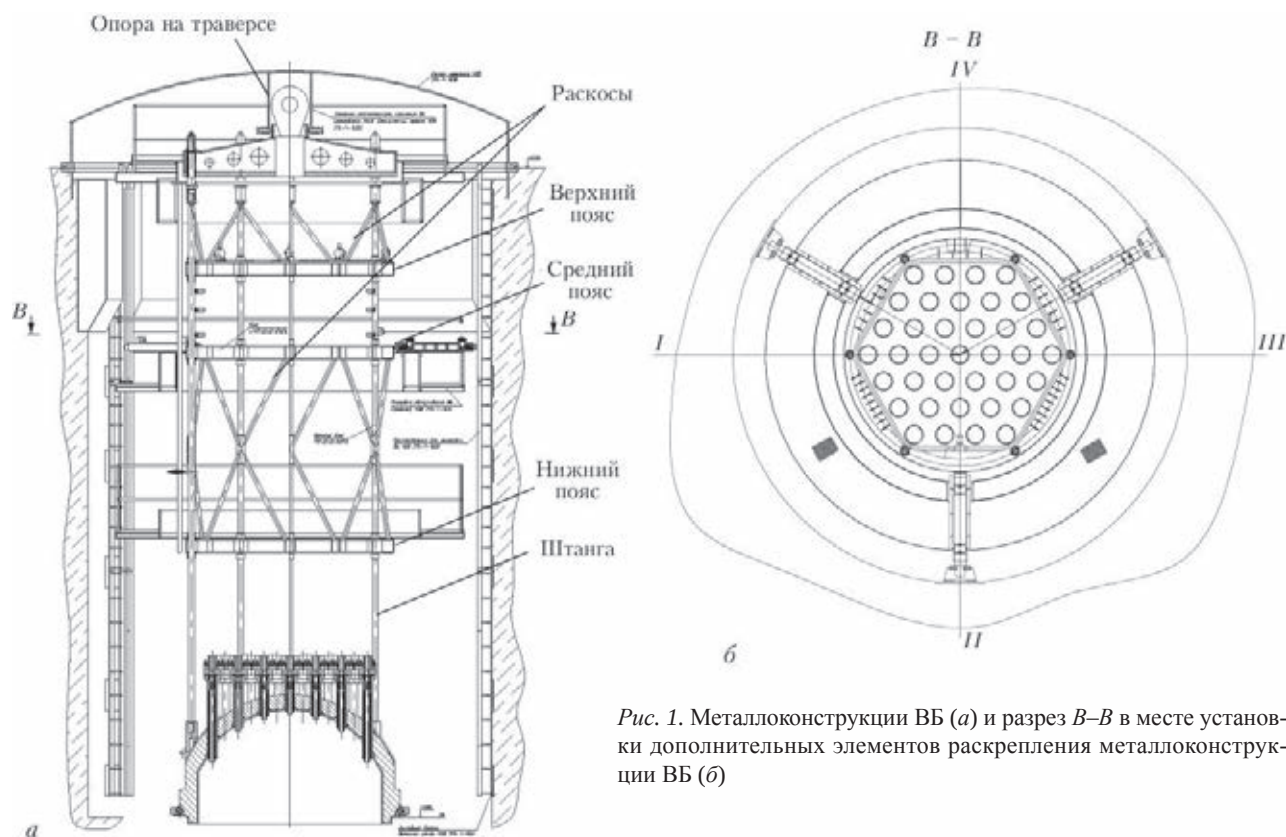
Металлоконструкции ВБ (а) и разрез В-В в месте установки дополнительных элементов раскрепления металлоконструкции ВБ (б)
